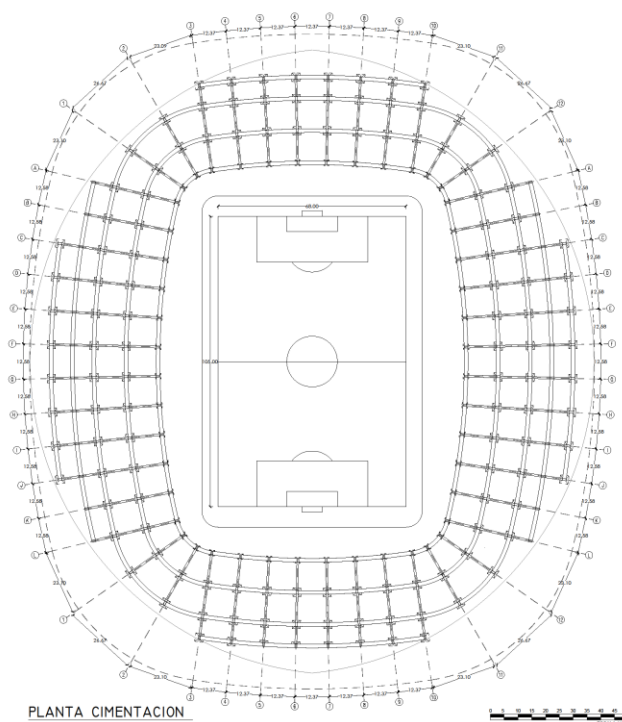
Plano de Cimentacion / Fuente Elaboración Propia
